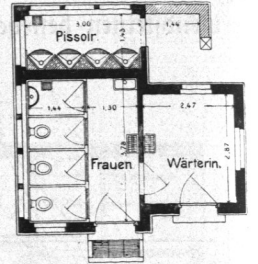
Bedürfnisanstalt Horner Landstraße, Grundriß.
